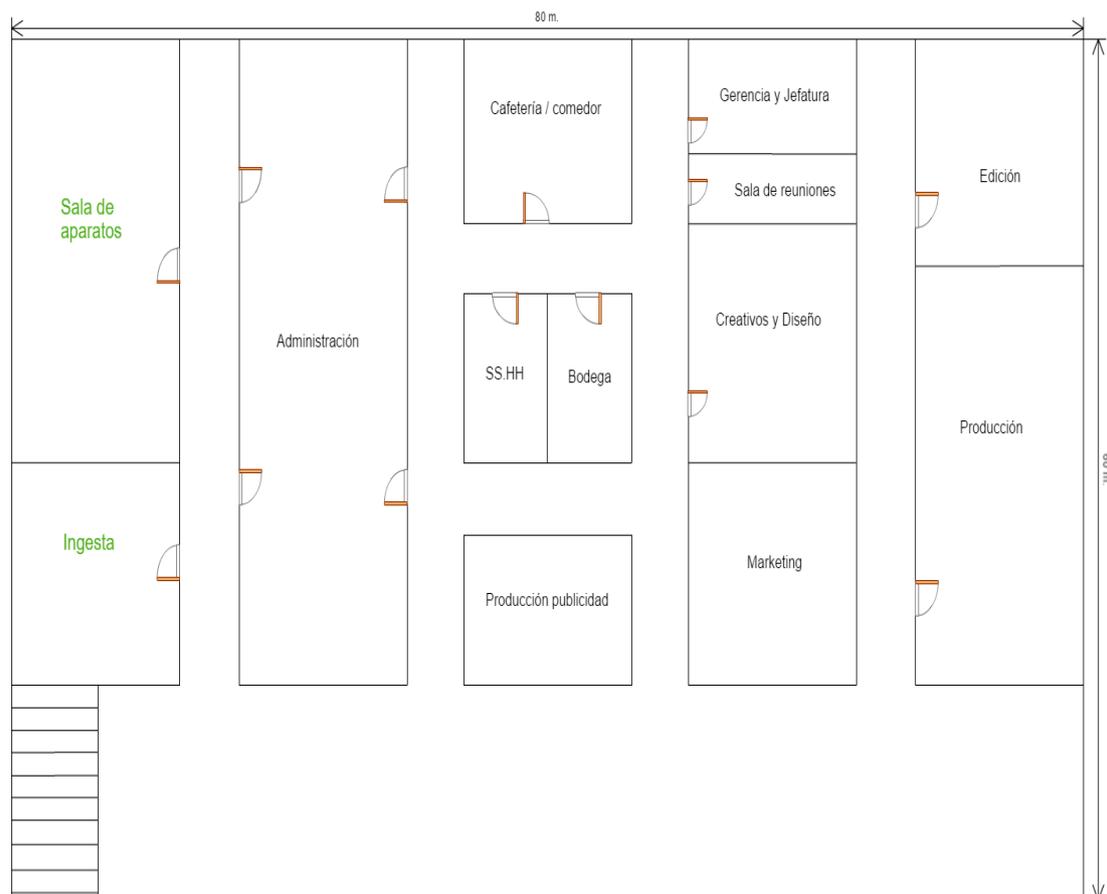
Plano primer piso del canal de televisión dividido en áreas.
